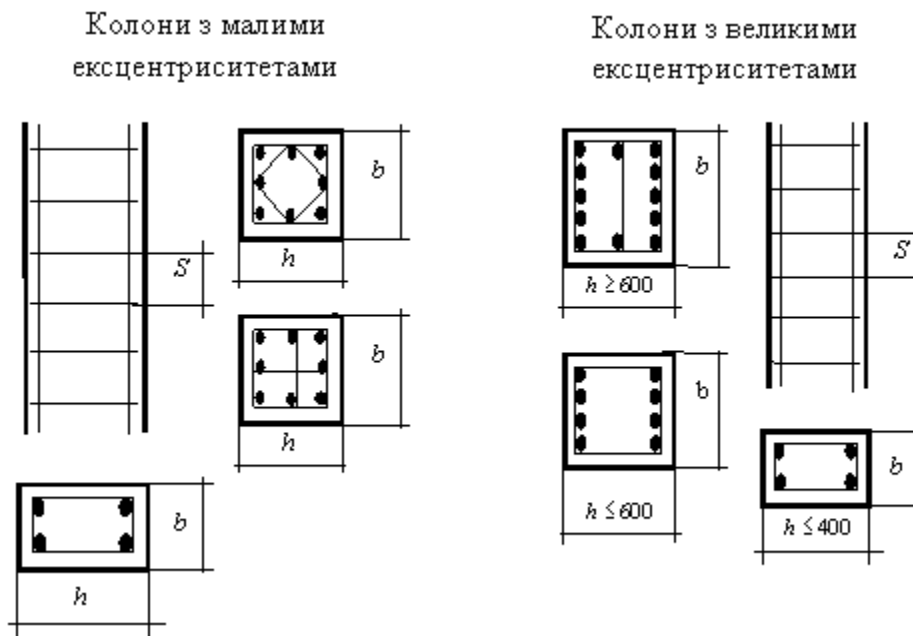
Схеми розташування подовжньої та поперечної арматури у залізобетонних колонах
